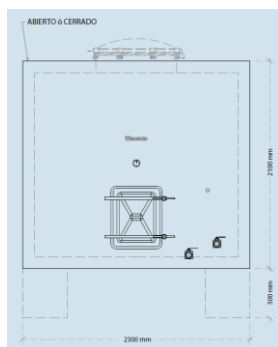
Esquema de depósito paralelepédico de hormigón armado prefabricado. 8,2 m³.
